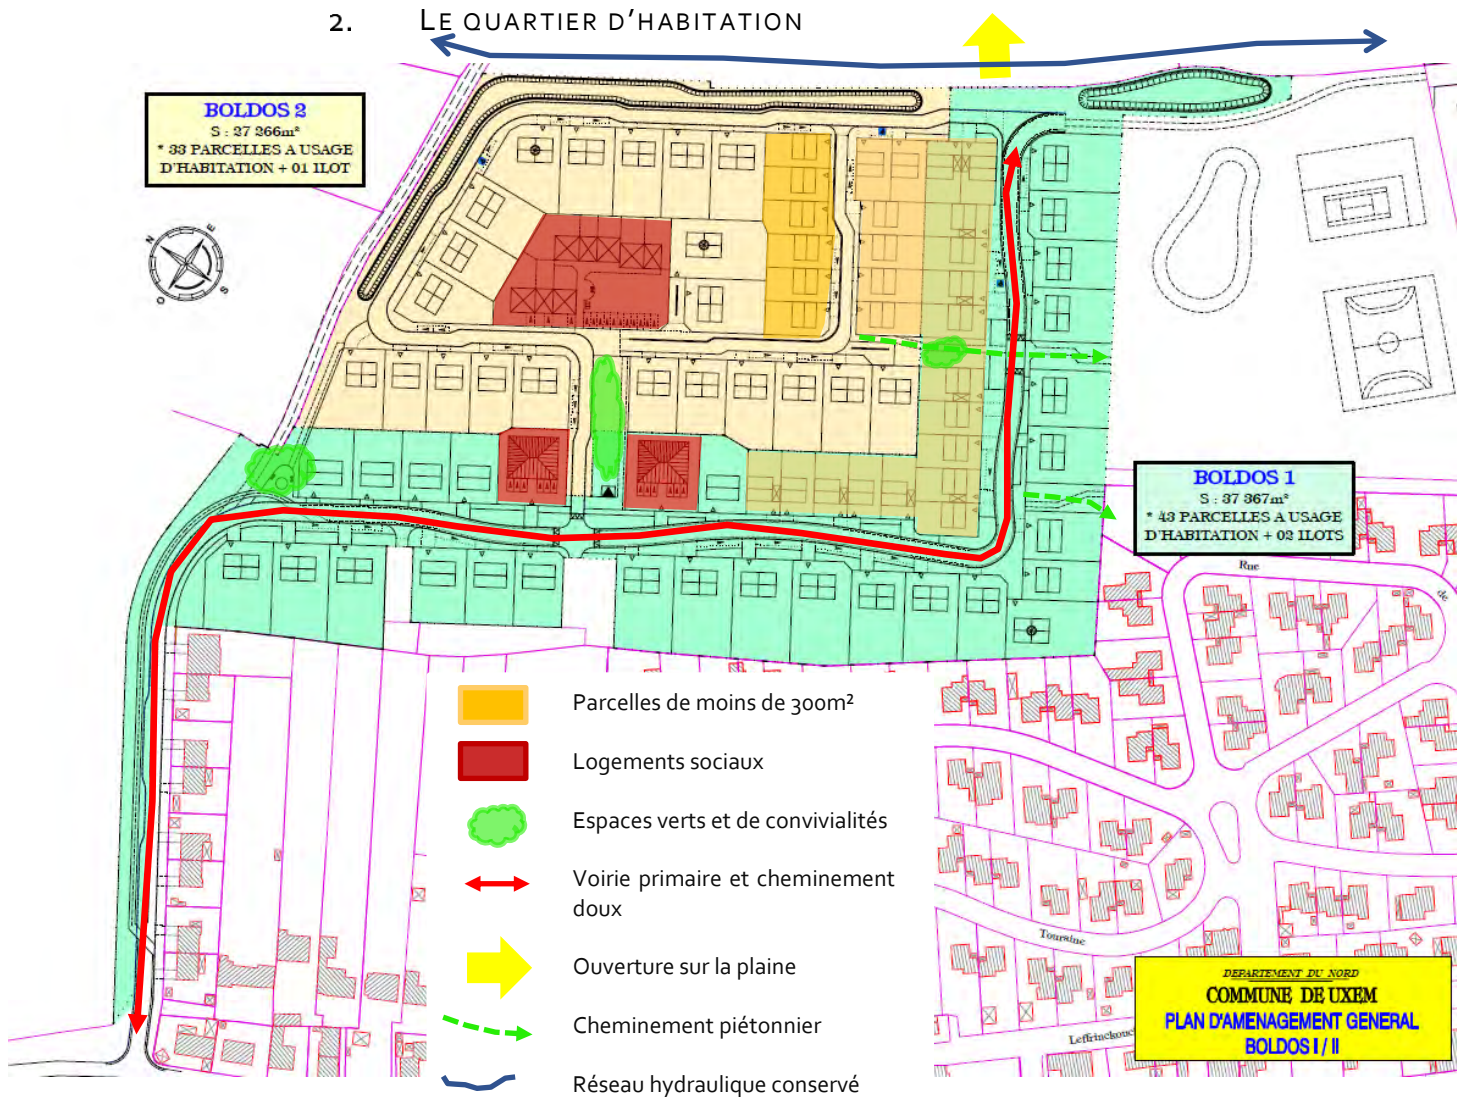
PLAN DE MASSE DU PROJET D'AMENAGEMENT
